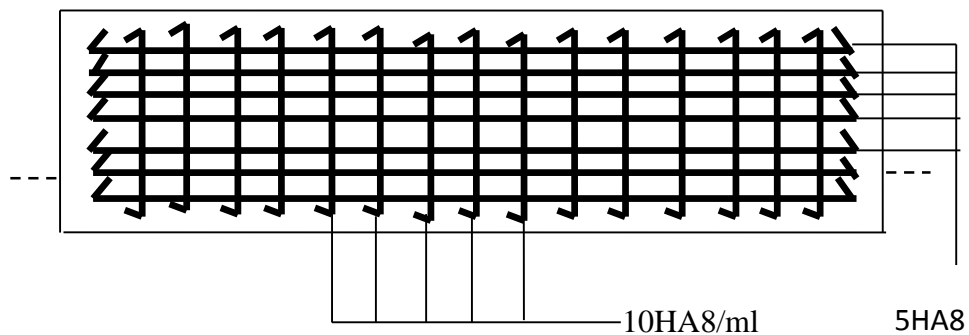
Schéma de ferrailage Semelle filante sous Voile adossée.
